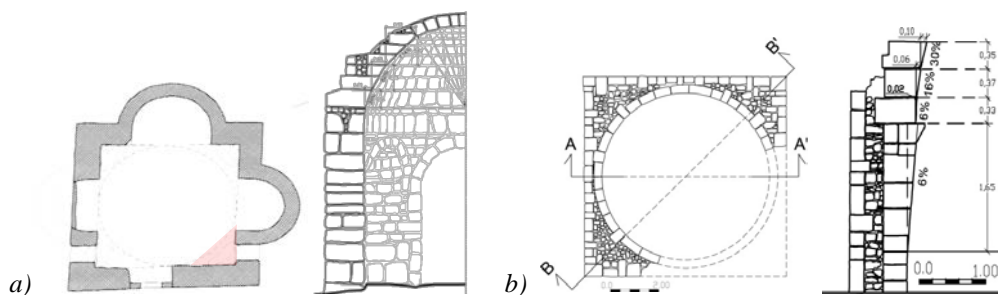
a) pianta e sezione della “trigona di cittadella”; b) pianta e sezione della “favorita” di Noto.
